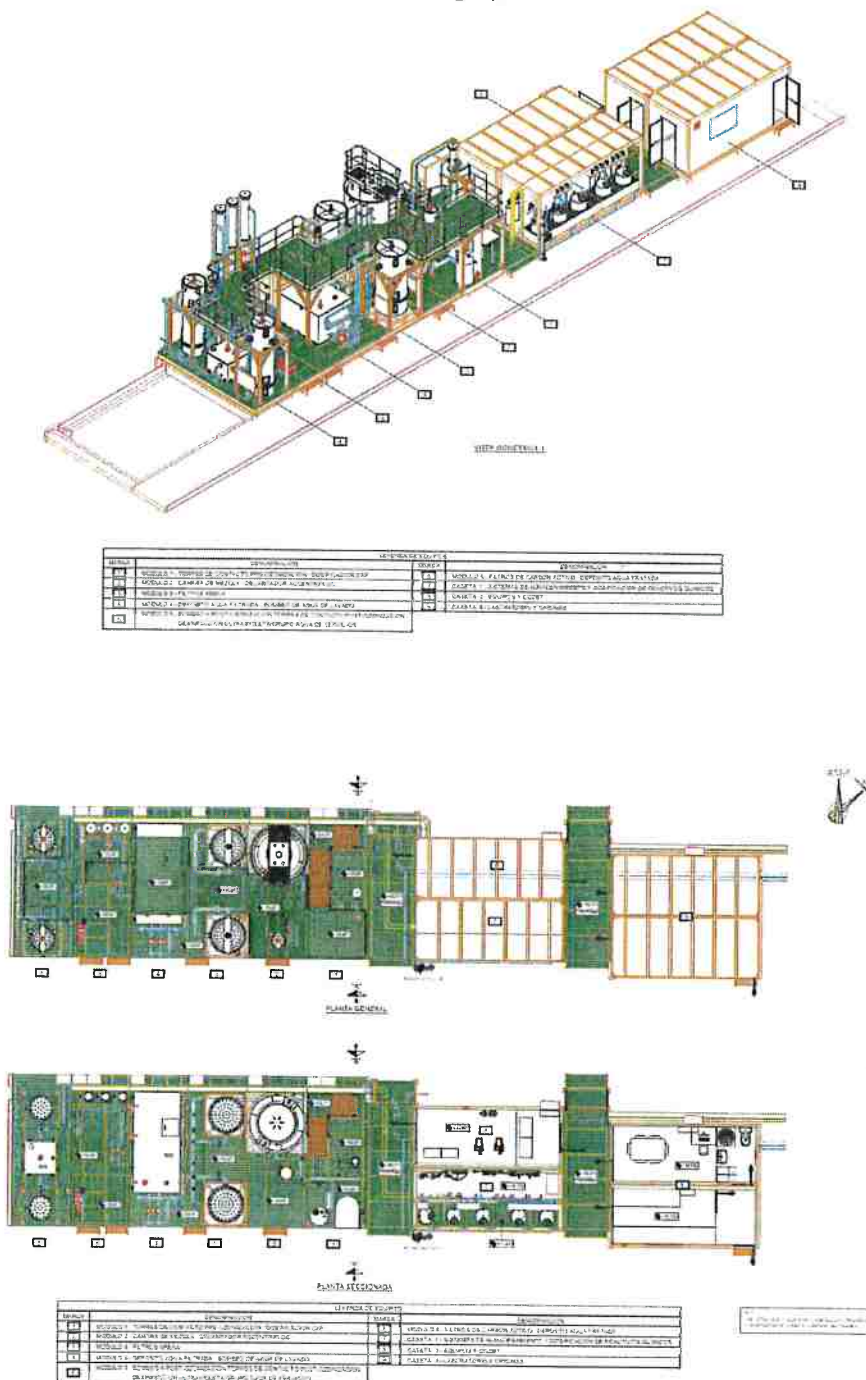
Plano de Planta piloto (ref. Proyecto Constructivo. Planos de Implantación –Infografías. 200.0917.PP.203.03.00.01.-V02)
